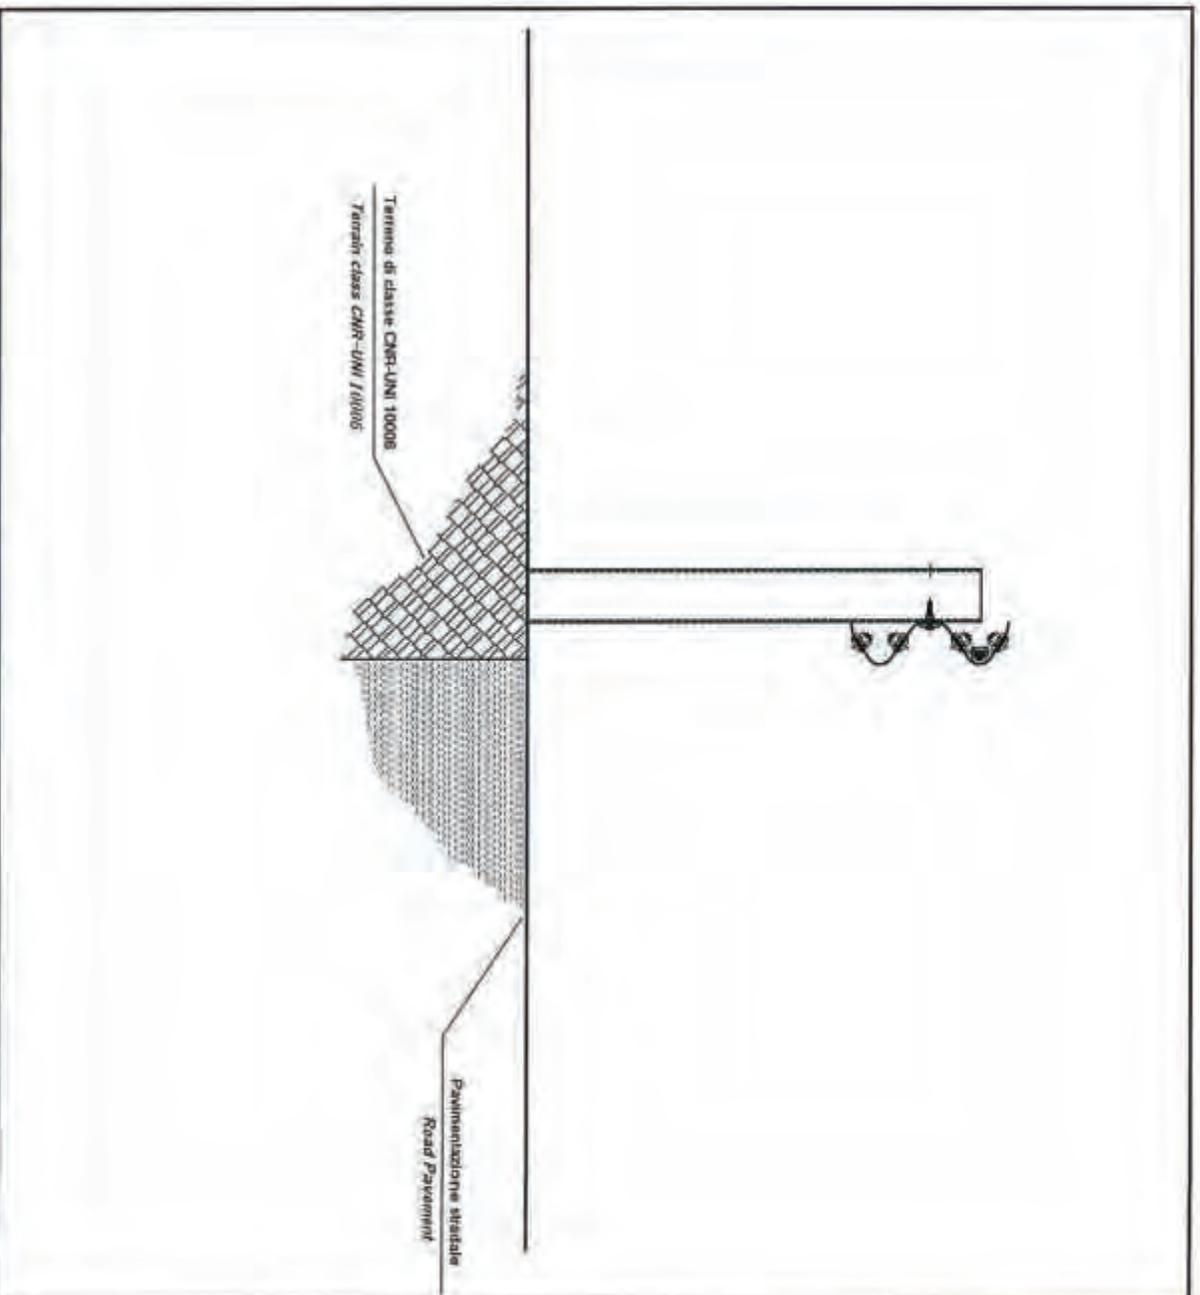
Figure 2 Sezione dell'installazione – The installation section
